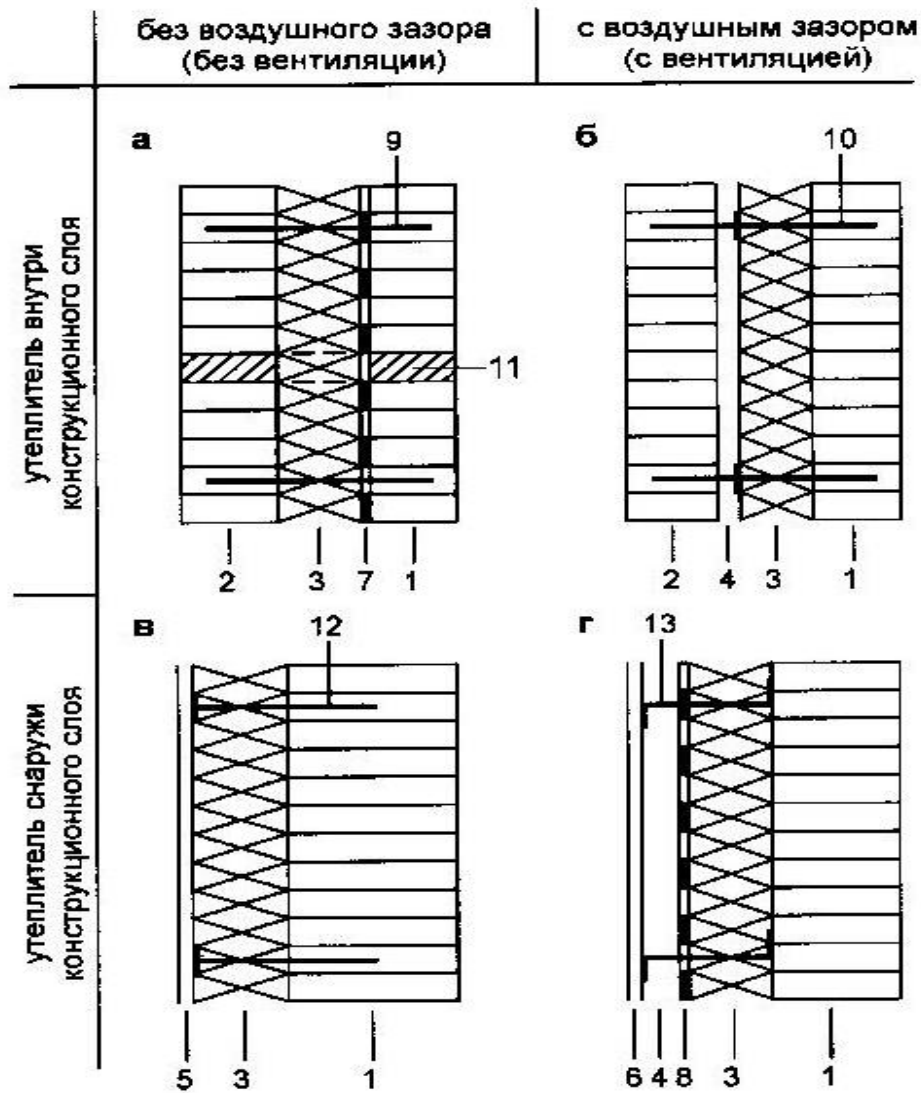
Принципиальные схемы основных конструктивных решений утепленных наружных стен:
